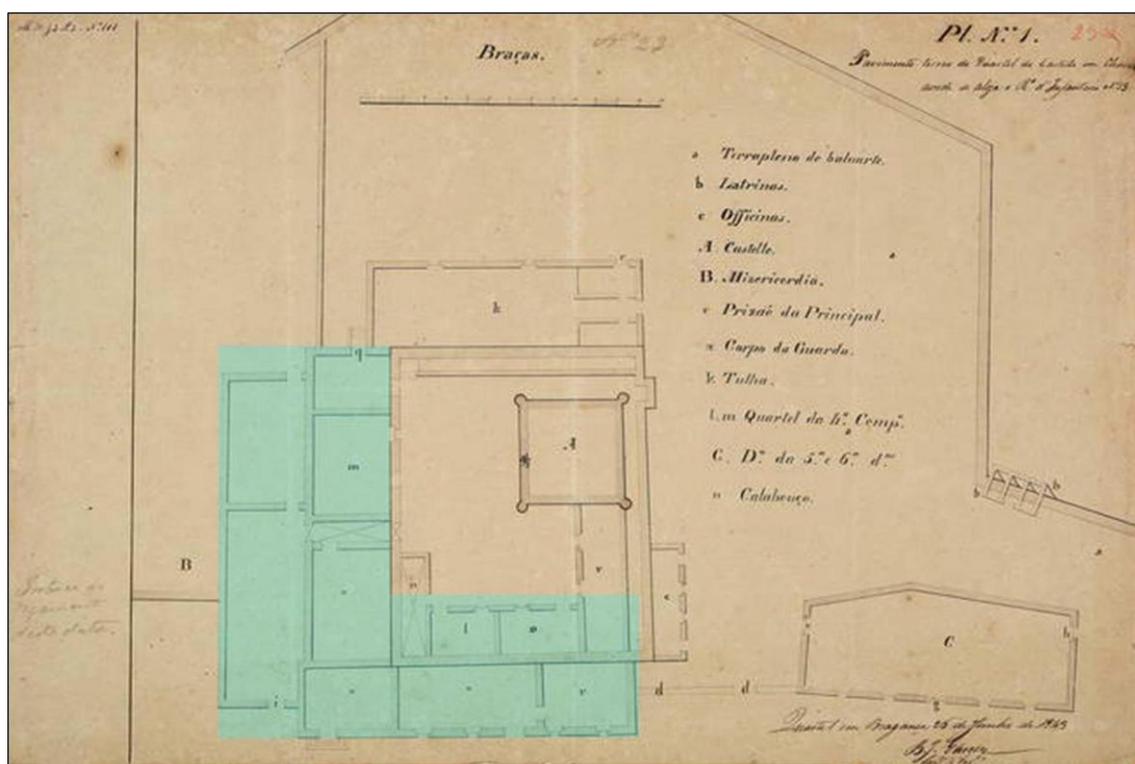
Planta do "Pavimento terreo do Quartel do Castello em Chaves aonde se aloja o R.º d'Infanteria nº 13 : Pl. nº 1 em Bragança 26 de Junho de 1843. AHM/GAEM 1460-1- 8-12" (adaptado de Gomes 2008:s.p.)
